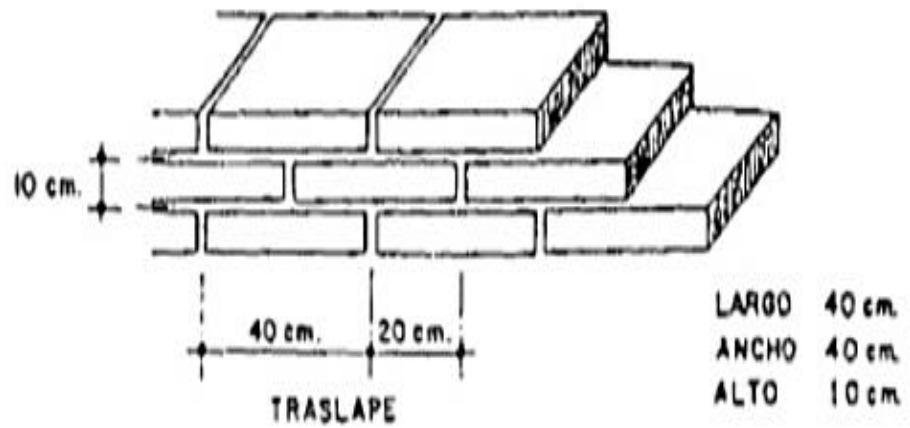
Traslape horizontal en adobes (Fuente; Imagen recopilada del Manual para la construcción de viviendas de adobe 1993)
